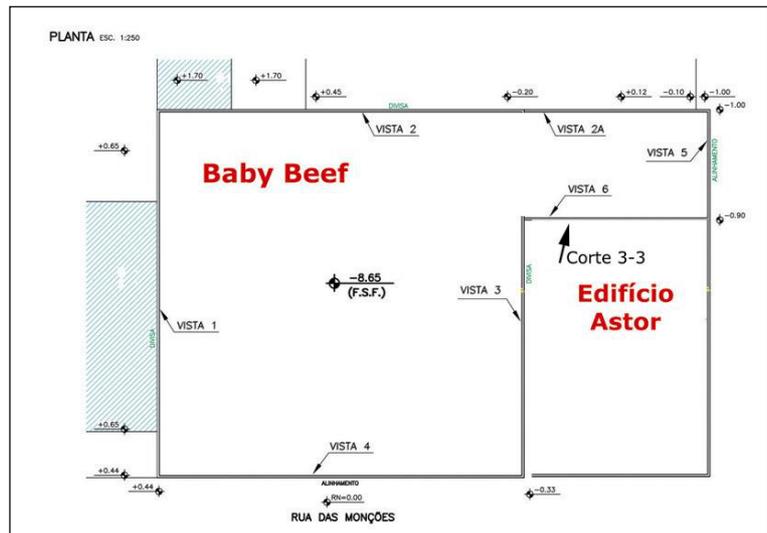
Alteração do projeto geotécnico devido a incorporação de nova área (Vistas 2A, 5 e 6).
